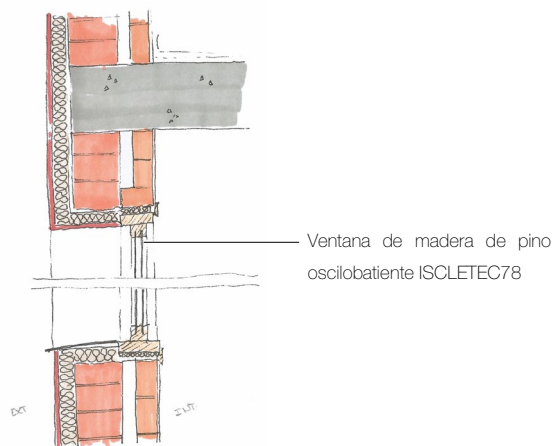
Detalle constructivo del hueco de ventana con el sistema SATE aplicado en la envolvente vertical (autoría propia).
